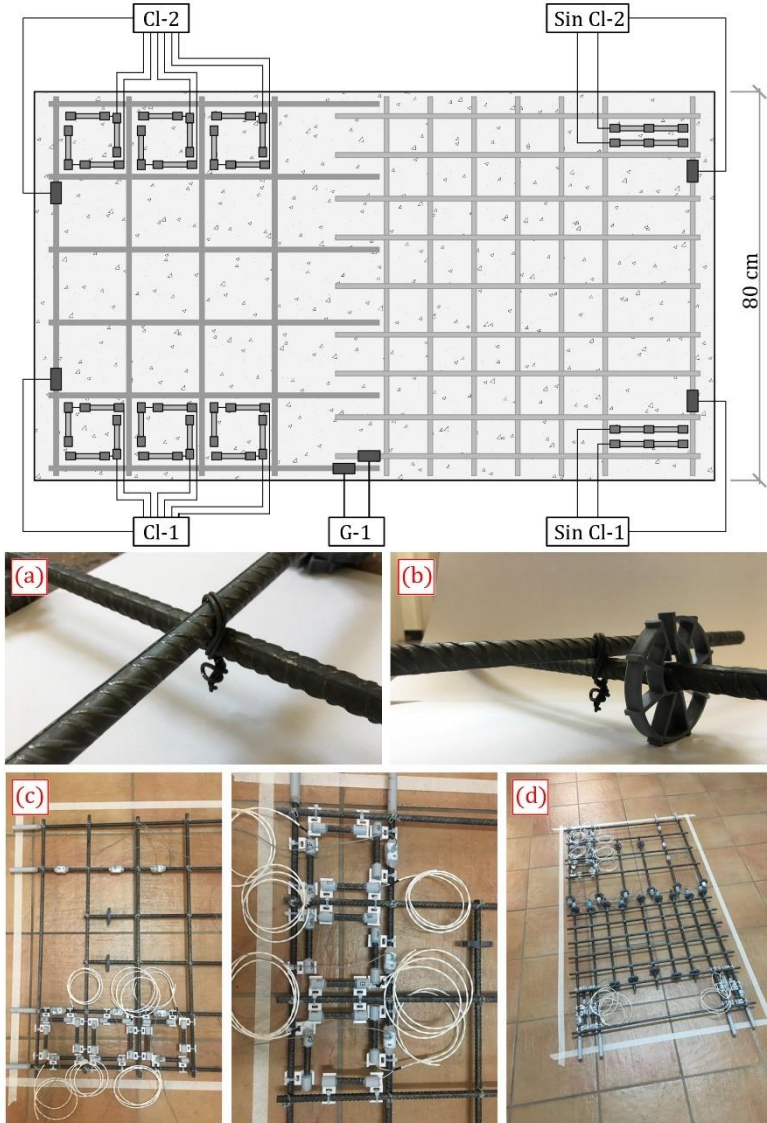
31- Geometría final de la losa. Proceso de preparación y montaje: (a y b) detalles de atado y separadores. (c) montaje y zona de sensores y (d) armado general. Elaboración propia.
